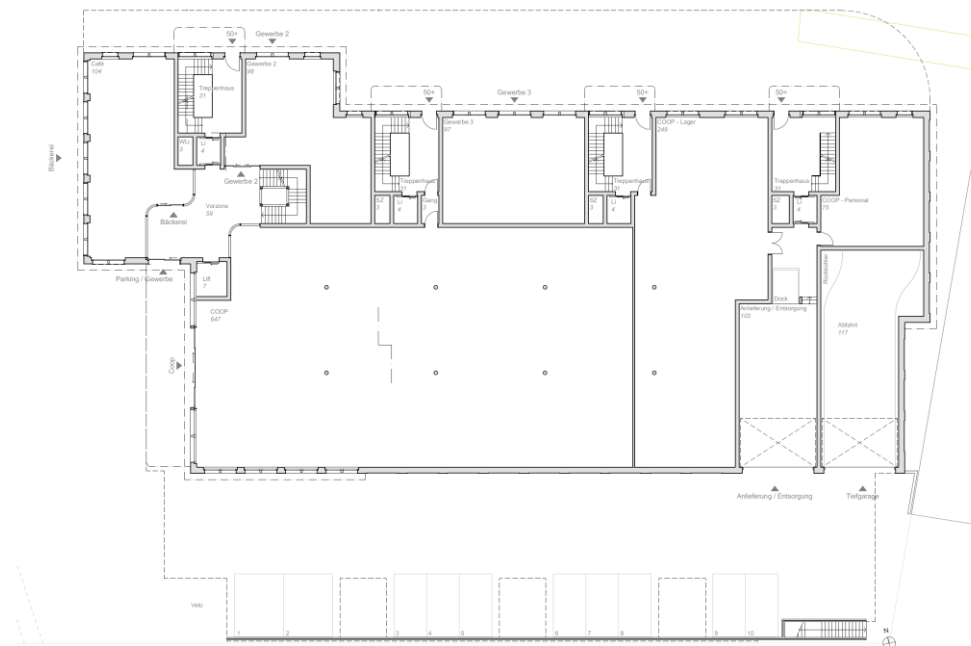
Erdgeschossplan Situationsplan Richtprojekt Architektur (bparchitekten, 2026)
